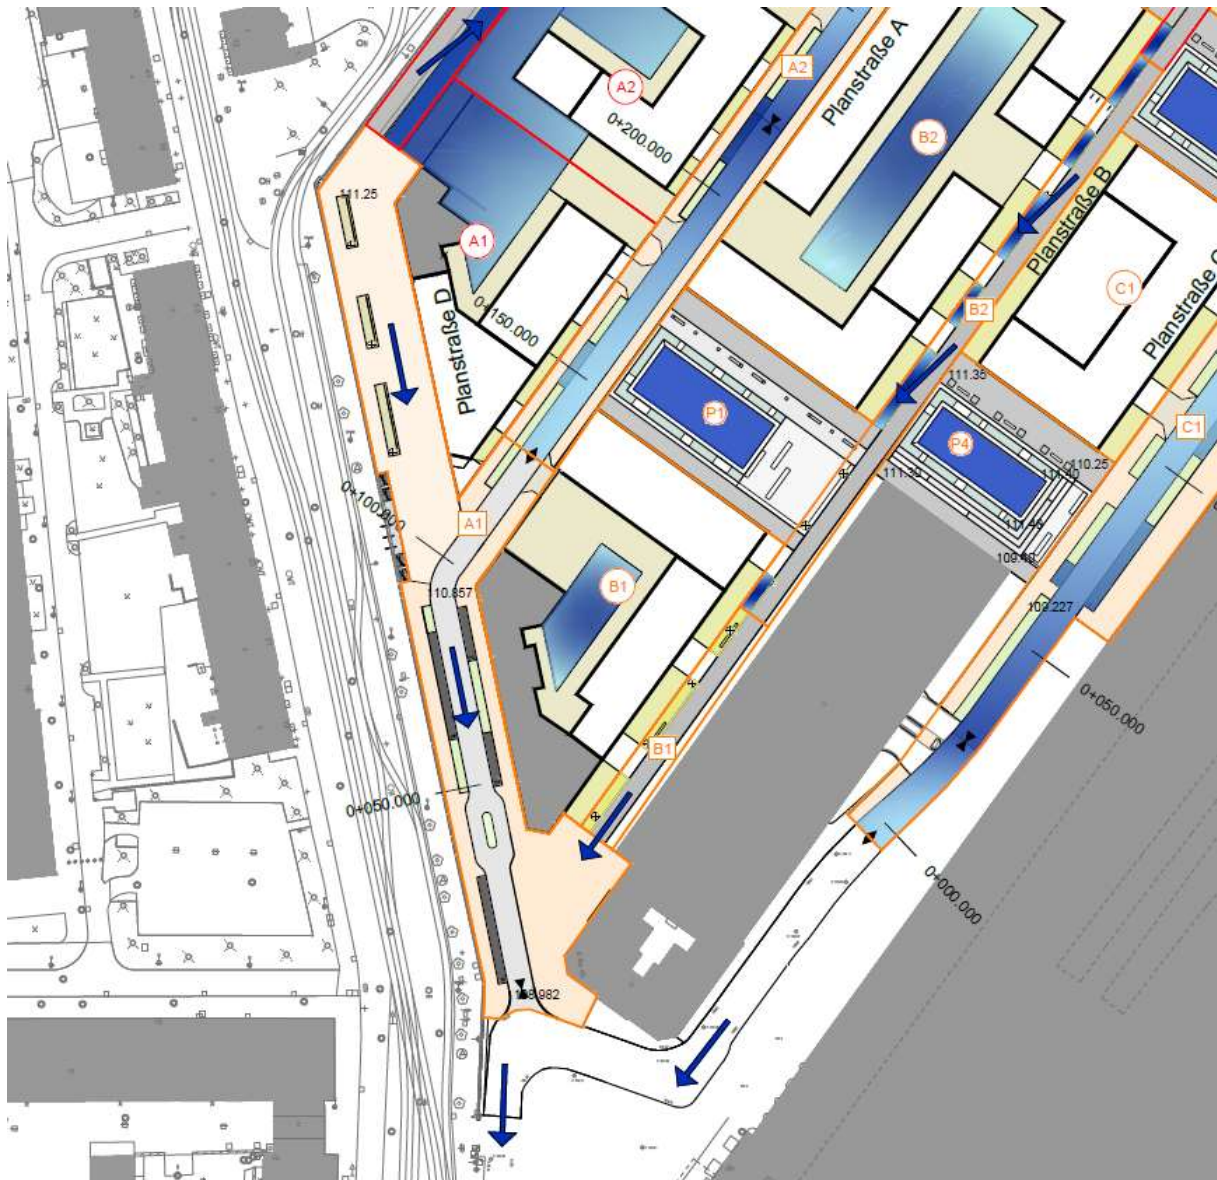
Ausschnitt aus Plan Nr.:1.1
